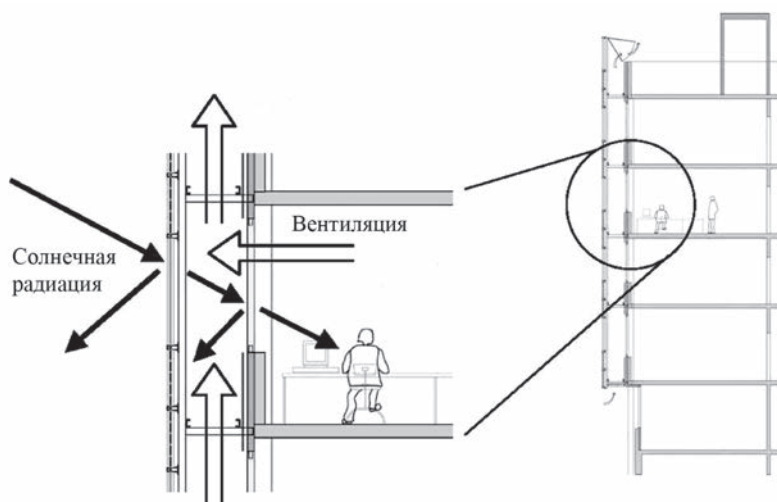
Общая концепция двойного стеклянного фасада — создание буферной зоны между основной светопрозрачной оболочкой здания и наружной средой [11]
